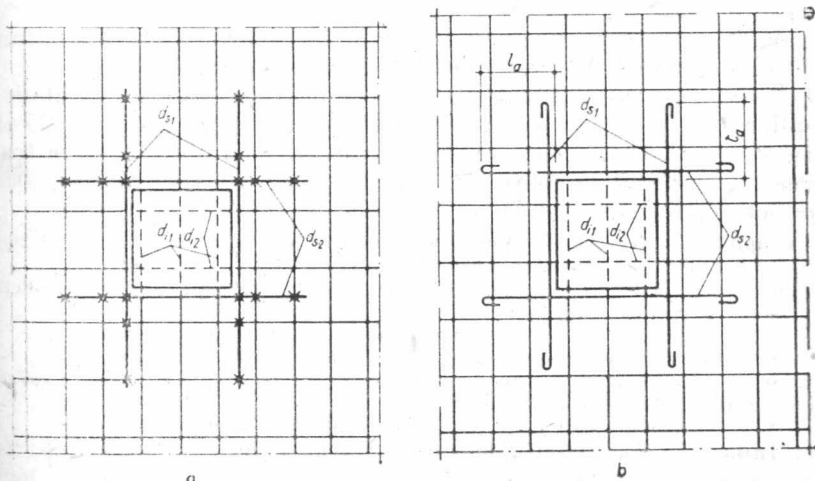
Barele de bordare ale golurilor în plăci de beton armat cu plase sudate :
